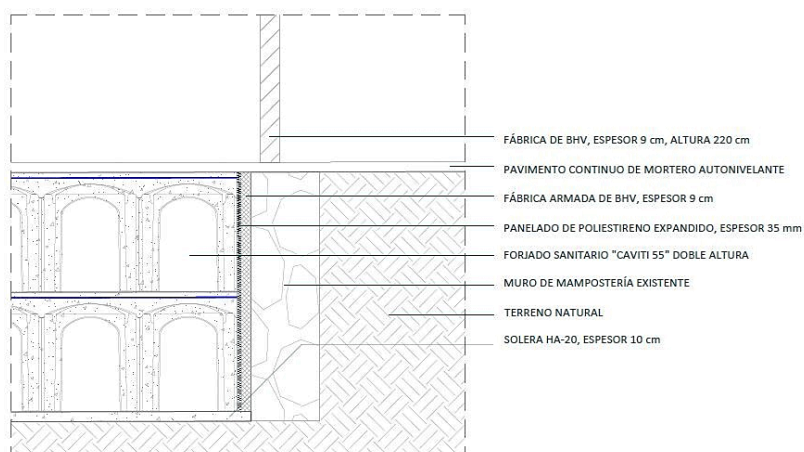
Detalle del proyecto de ejecución del forjado Caviti®. Fuente: elaboración propia.
